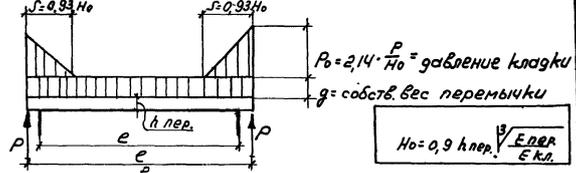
Схема нагрузок на перемычку при расчете по случаю «д».
